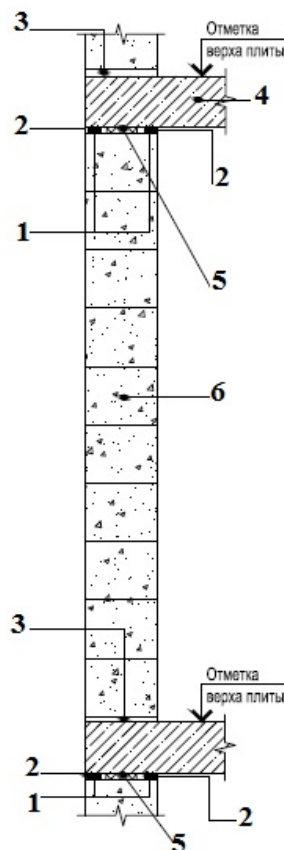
Схема кладки наружных самонесущих стен с поэтажным опиранием в каркасно-монолитном строительстве: 1 — упругие прокладки из поризола; 2 — затирка цементно-песчаным раствором; 3 — выравнивающий раствор; 4 — железобетонное перекрытие; 5 — минеральная вата; 6 — блоки YTONG
